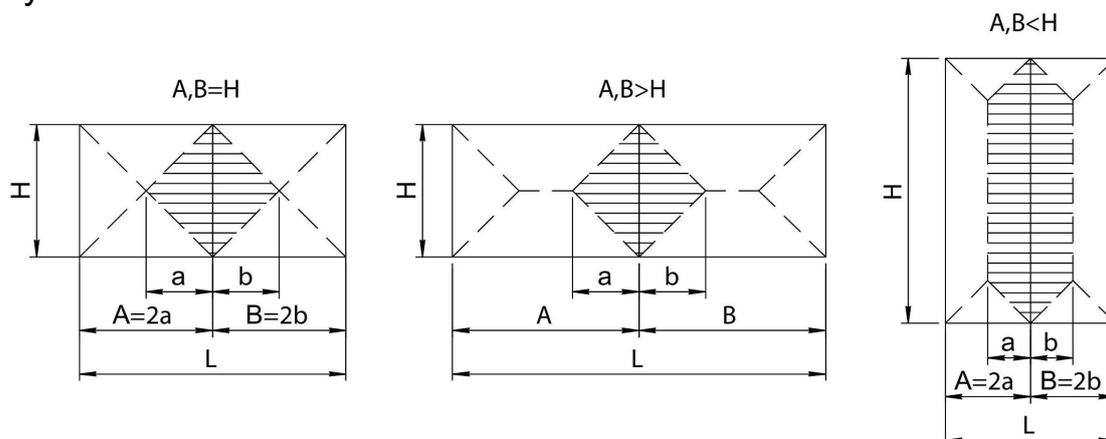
Расчетная схема ветровой нагрузки W_m
